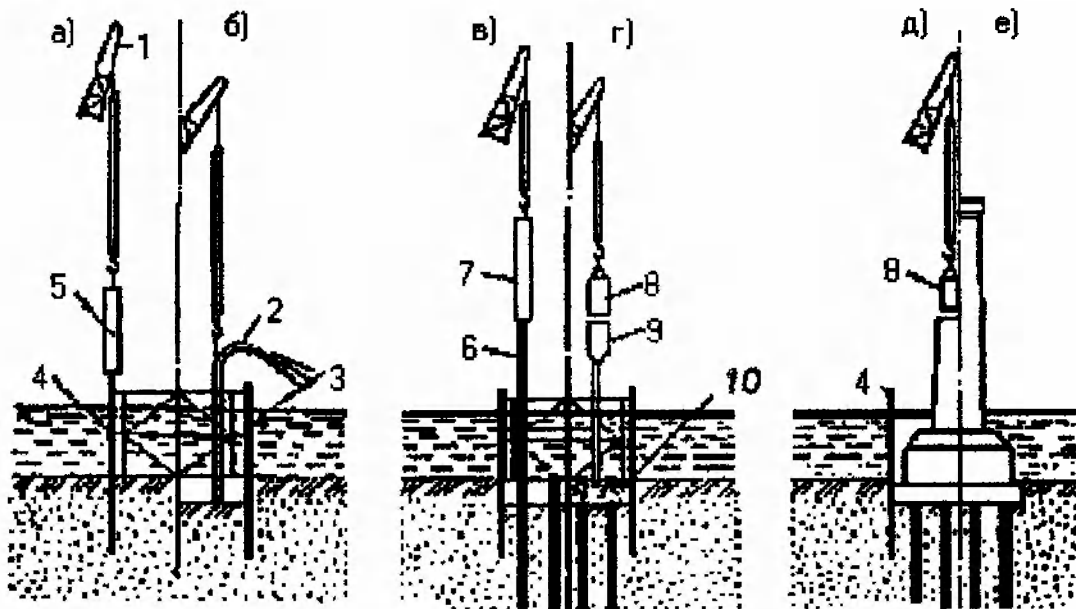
Последовательность работ при сооружении свайного фундамента с заглубленным в грунт ростверком:
